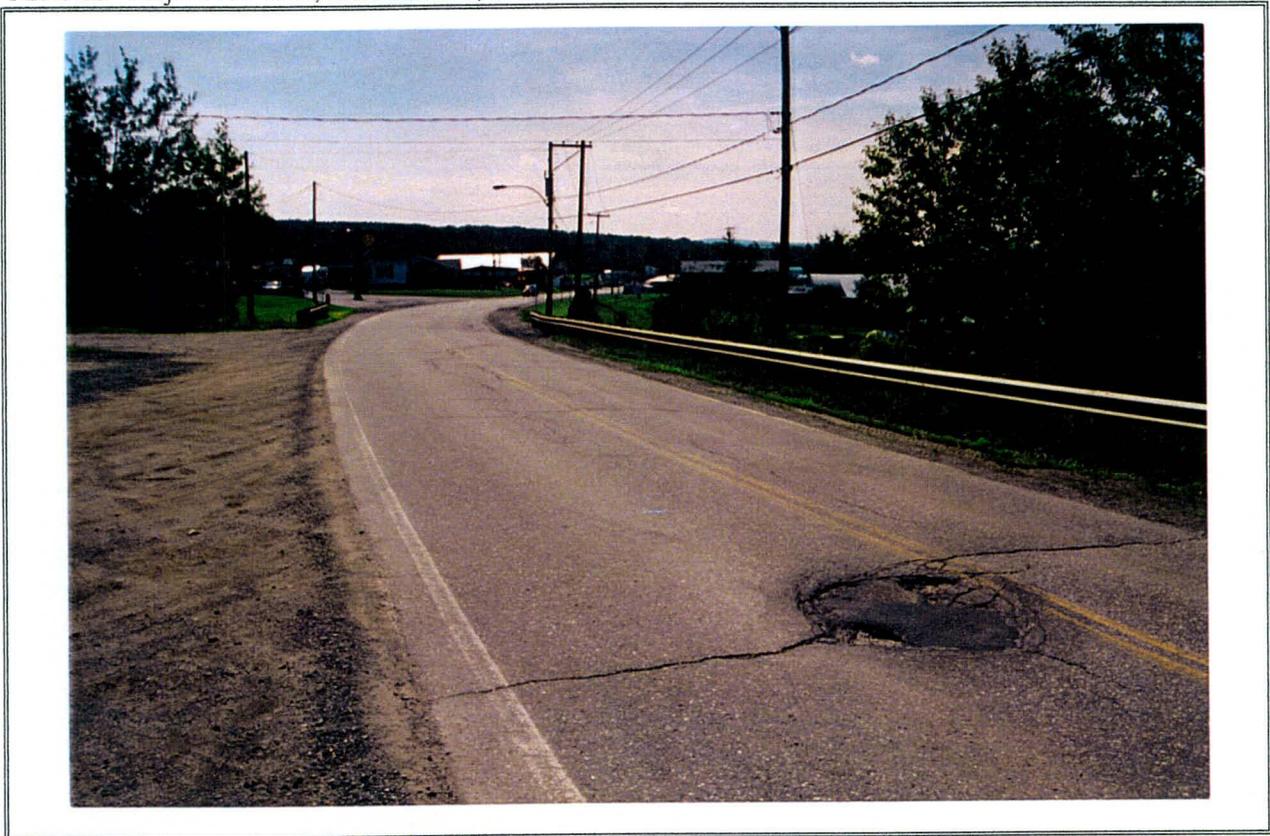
Projet 3476-9601, route 216-277, construction de la chaussée, Saint-Malachie, 4+760 – 4+900 (NO)
